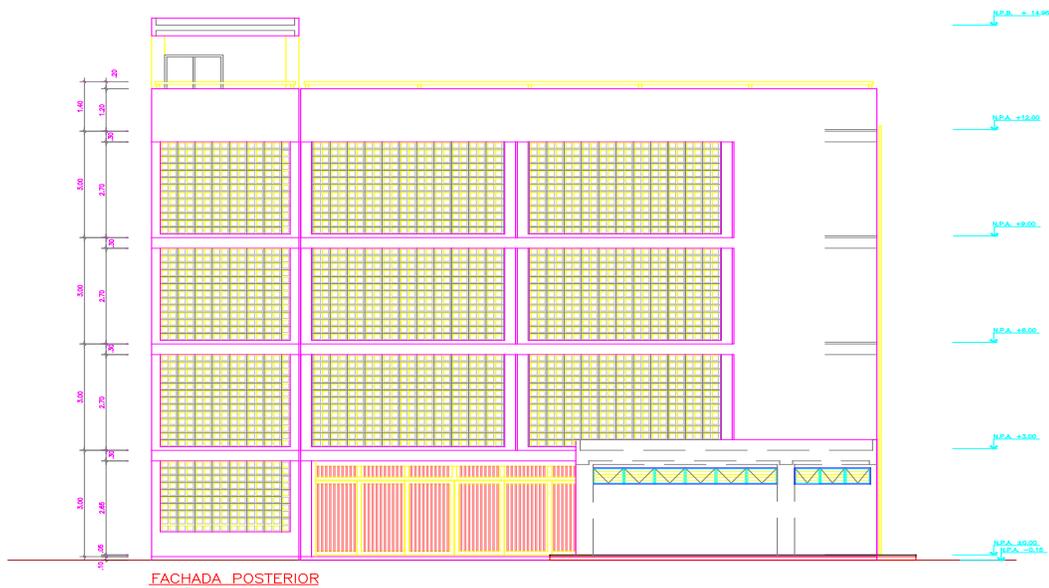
Plano de Fachada Posterior, Sistema Constructivo “Módulo de Barrio”, Fuente: Librería por Sistemas Constructivos de F.E.D.E., Enero 2016.
